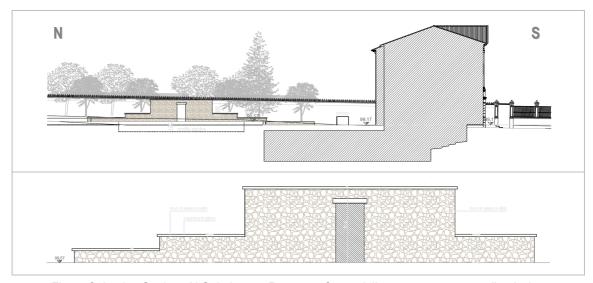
In alto: Sezione N-S, in basso: Prospetto Ovest della struttura annessa alla piscina.
